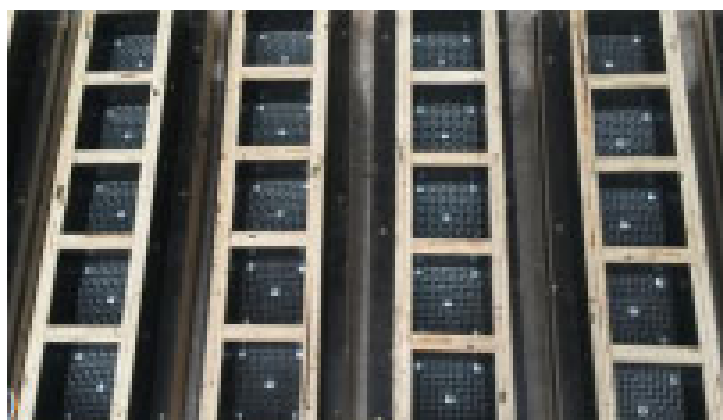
Fixação dos corpos de prova no pórtico metálico
